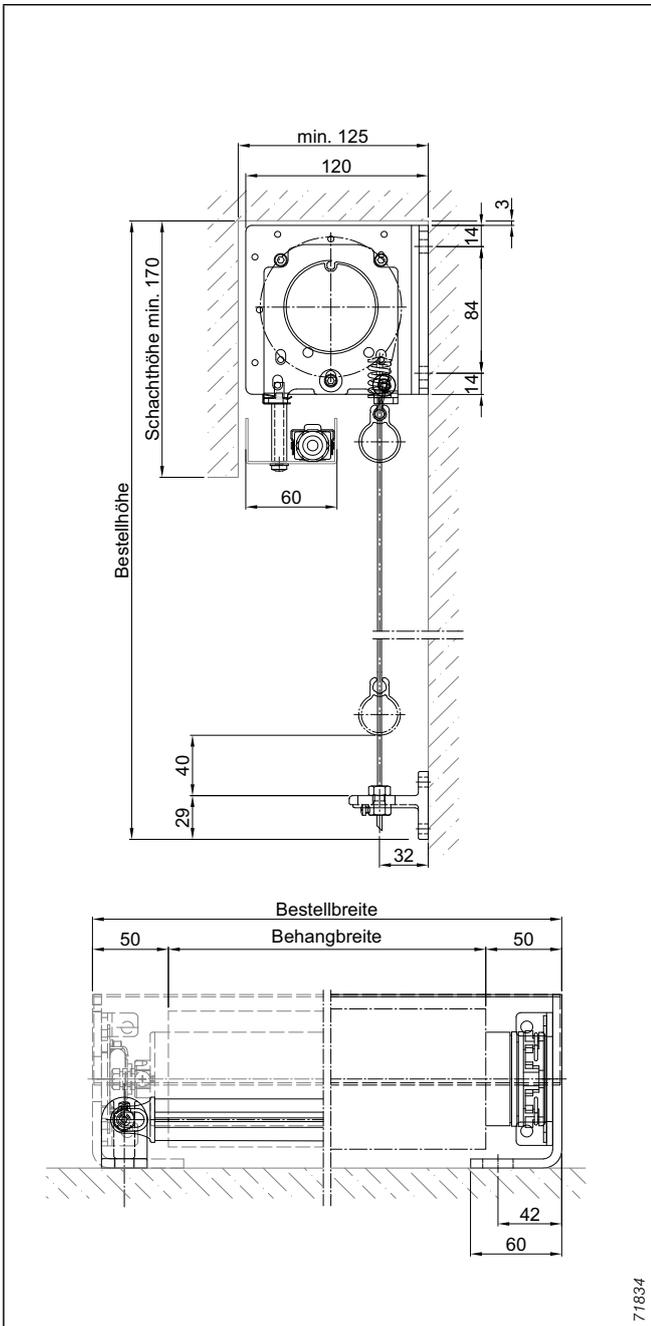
Rechtsroller, Schienenführung, Deckenmontage mit Revisionsblende
